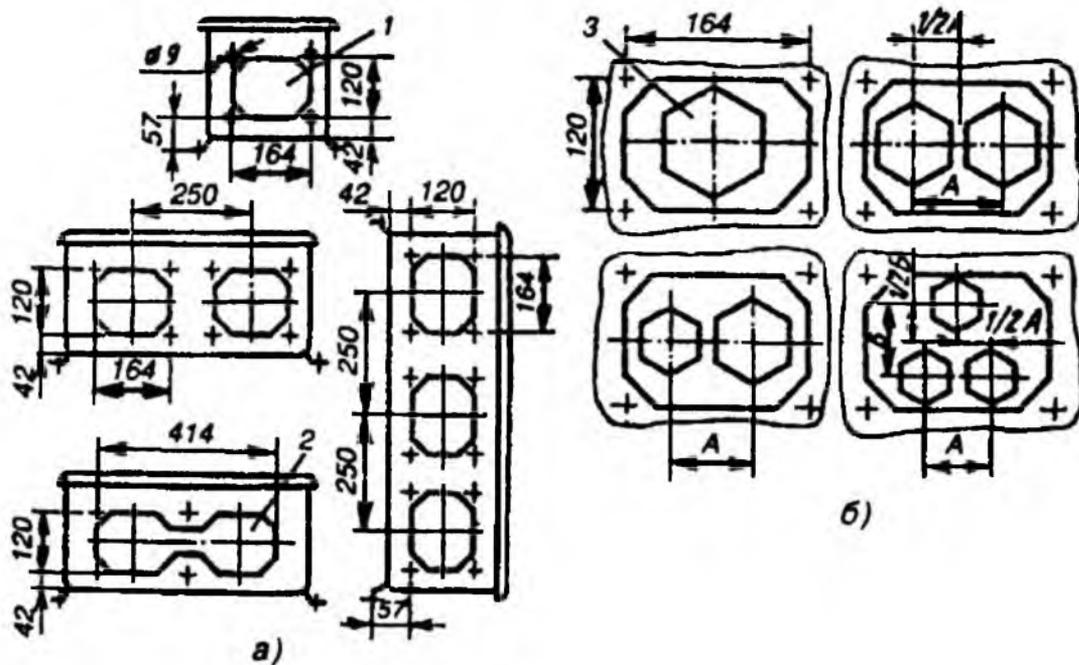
Размеры и расположение соединительных окон проходными отверстиями ящиков РУС-Е:
